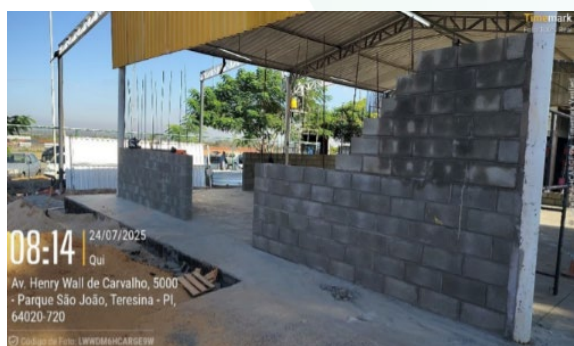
Instalação de calha de zinco, barras metálicas e telhas trapezoidais em fachada e cobertura da construção.
